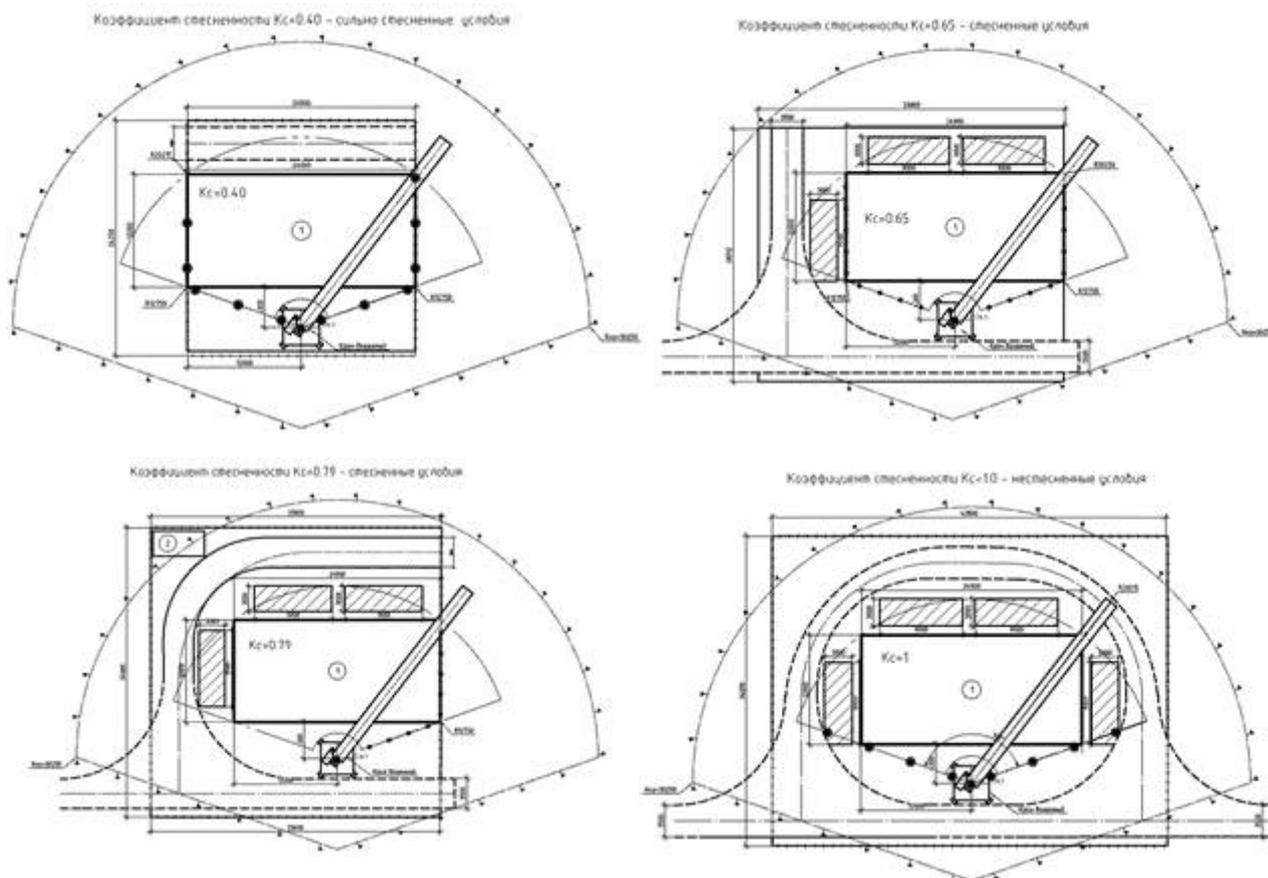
Организация строительной площадки при разборке конструкций башенным краном
